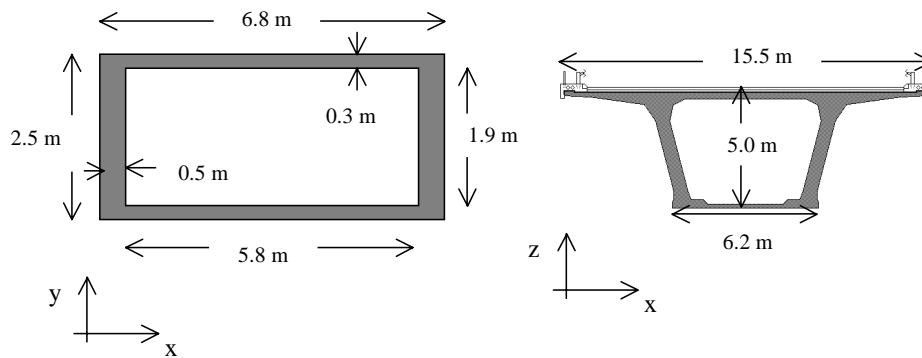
Sección transversal de las pilas (izquierda) y del tablero (derecha) del Puente Warth
